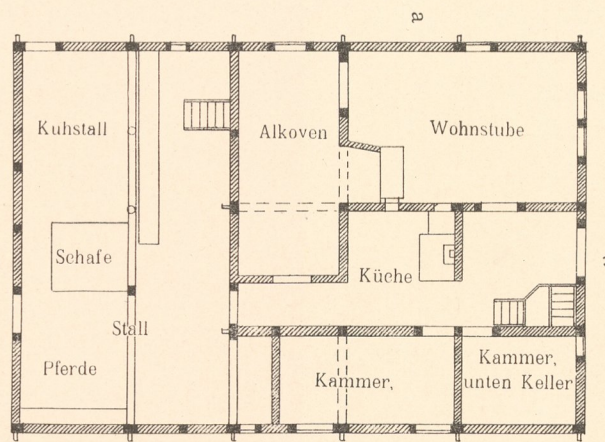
Alt-Blessin, Grundriss vom Erdgeschoss.
